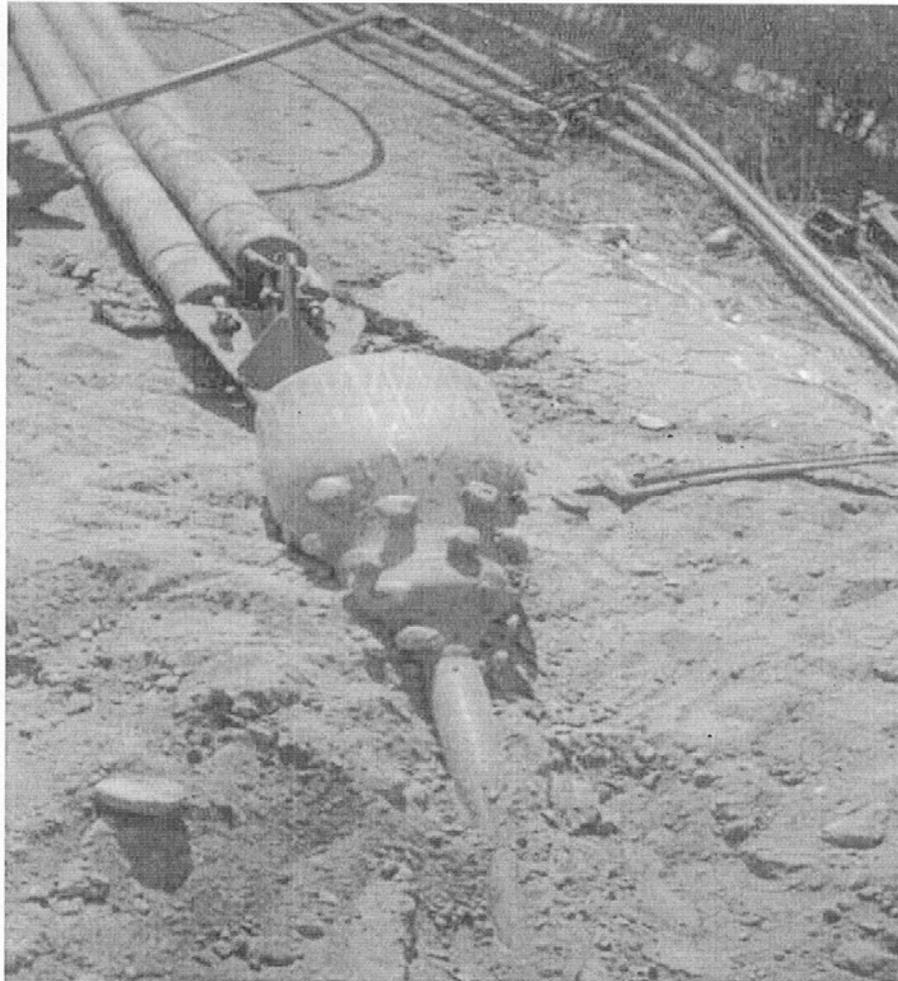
Aparato retroensanchador de 18" de diámetro
